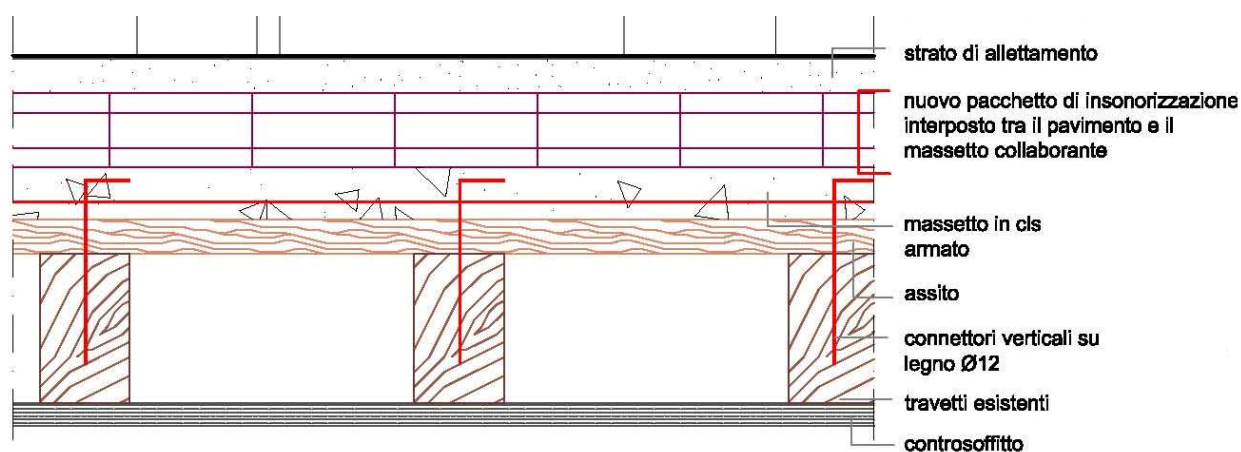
Sezione del progetto del pacchetto del solaio di piano primo.
